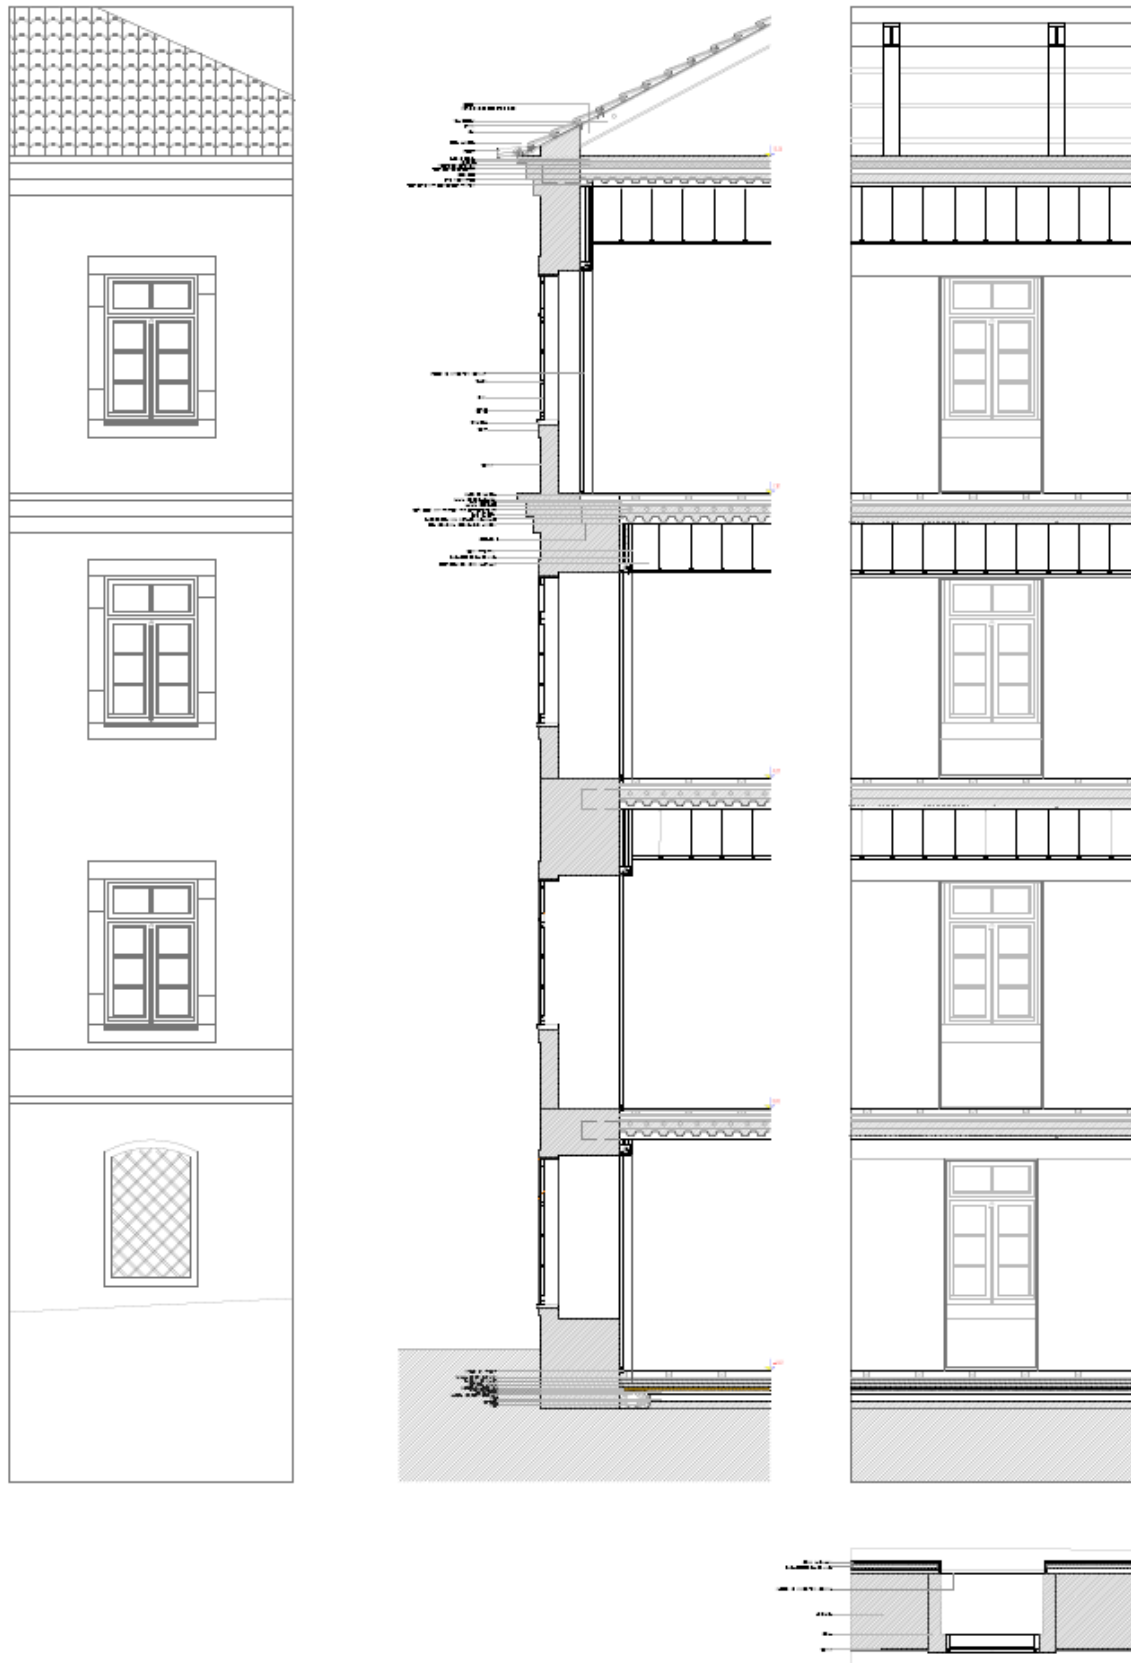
Pormenor construtivo da fachada tipo (sem escala)
